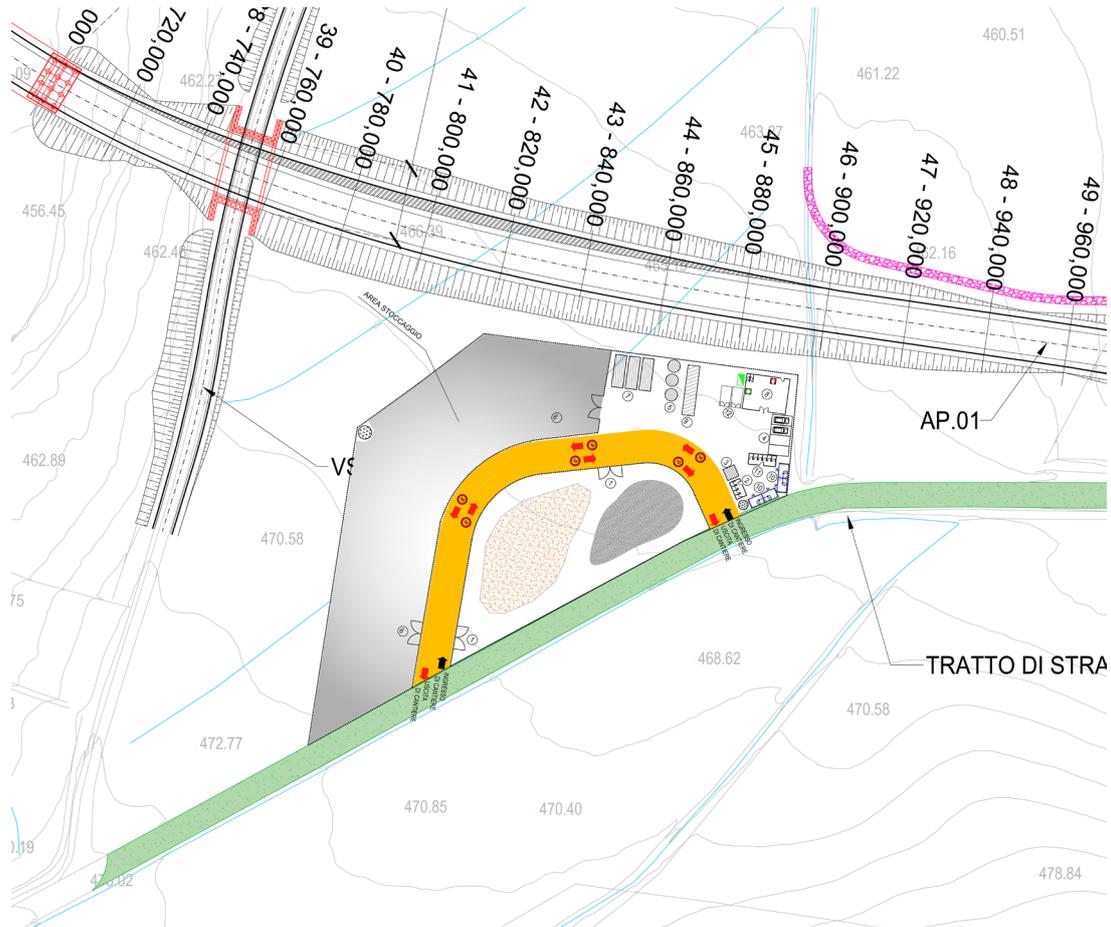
Layout cantiere CO01 (cantiere operativo)
